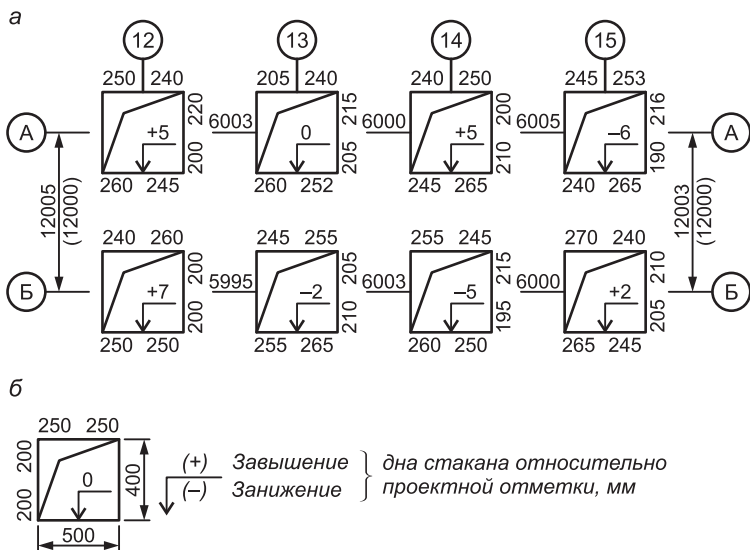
Схема исполнительной съемки фундаментов под колонны:
